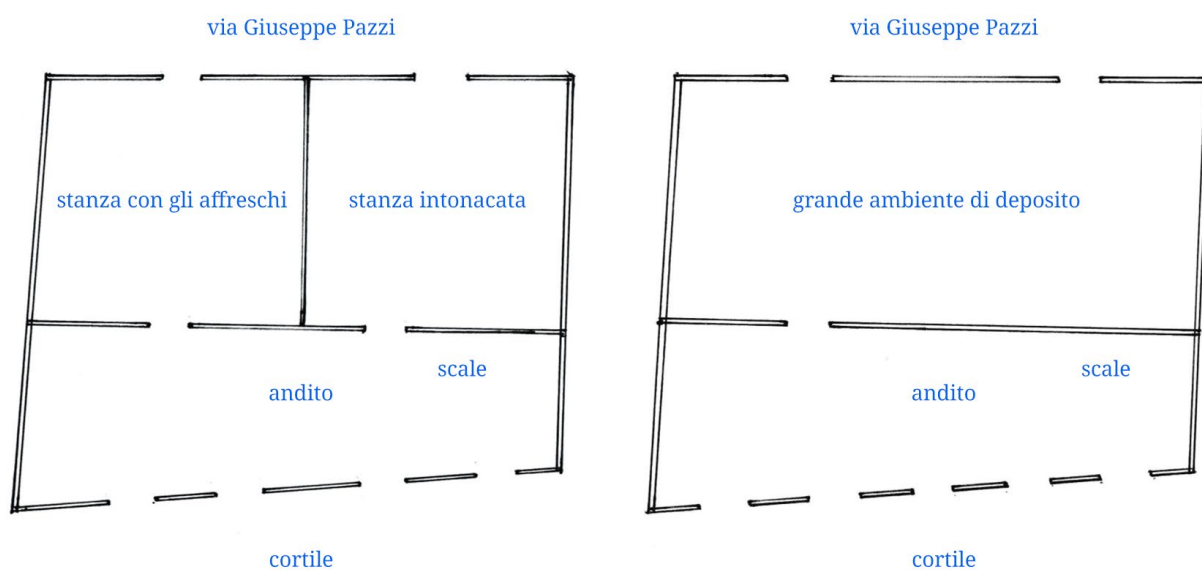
Ricostruzione sommaria della planimetria del secondo e terzo piano del palazzo di via Piazzi, 12.
